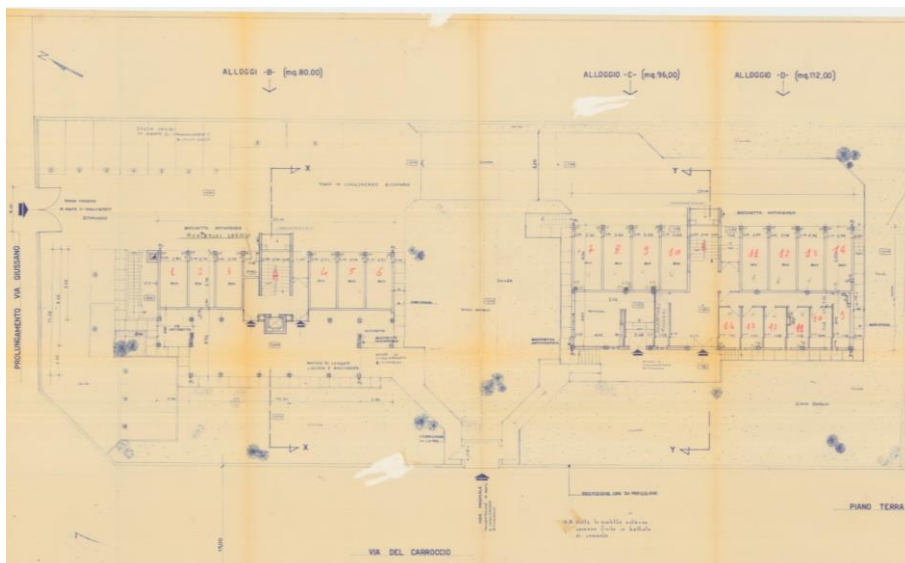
, Pianta Piano Terra, scansione progetto originale
